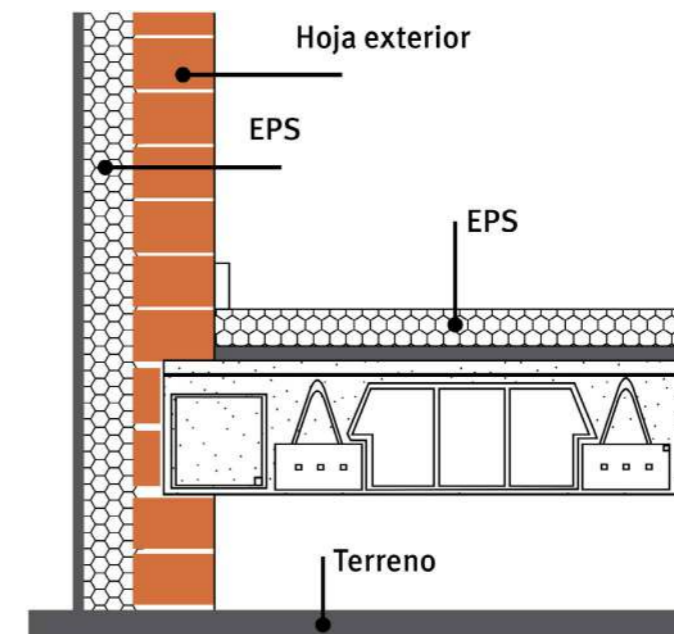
Detalle 3. Sistema SATE. Encuentro de fachada con el primer forjado del edificio.
